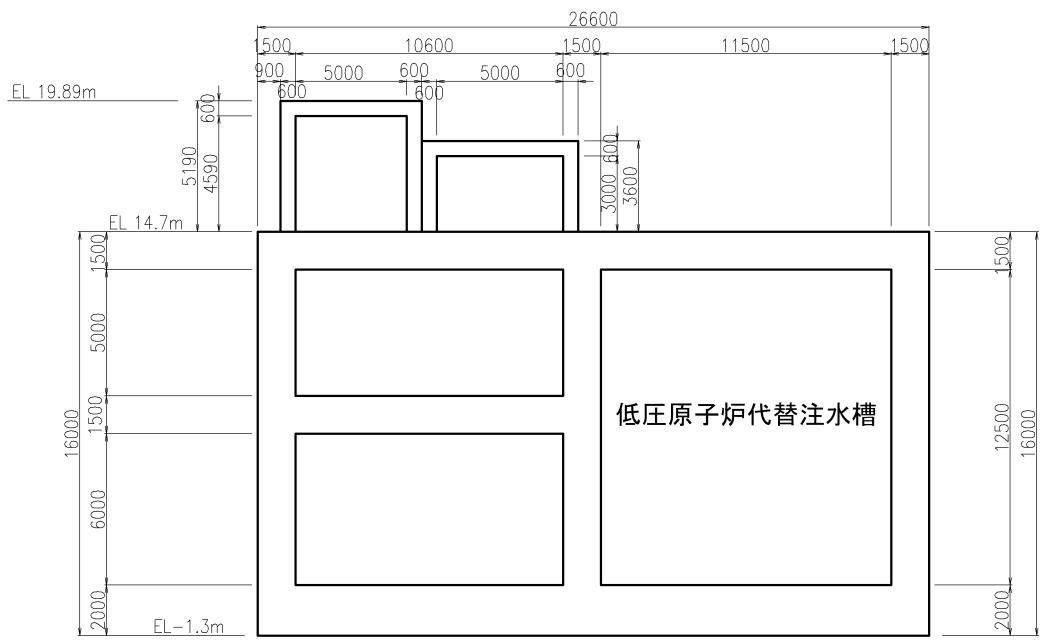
低圧原子炉代替注水ポンプ格納槽 断面図 (C-C 断面) (単位:mm)
